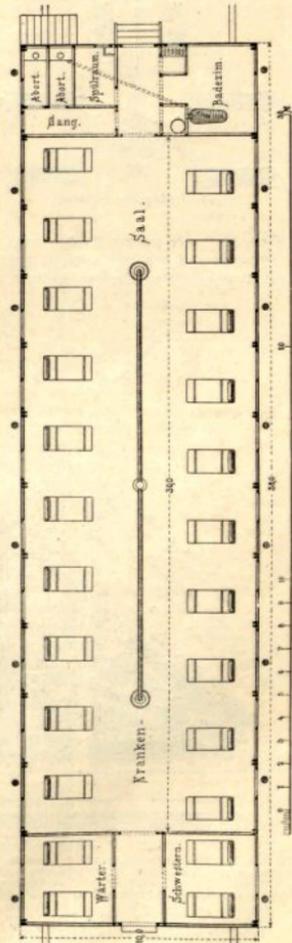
Grundriss der Baracken zu Paris (Architekt F. Jäger).
